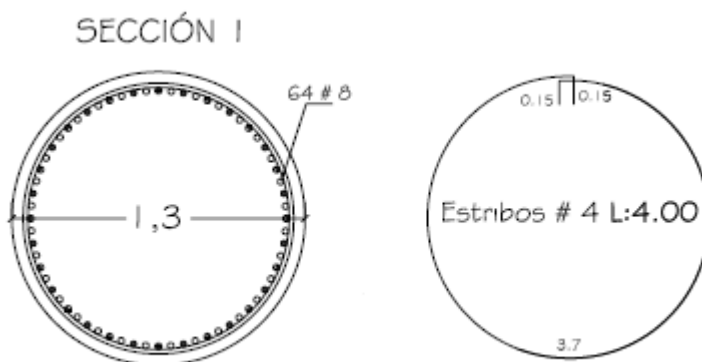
Refuerzo propuesto por Rodríguez (2010) para el problema de estabilización.
